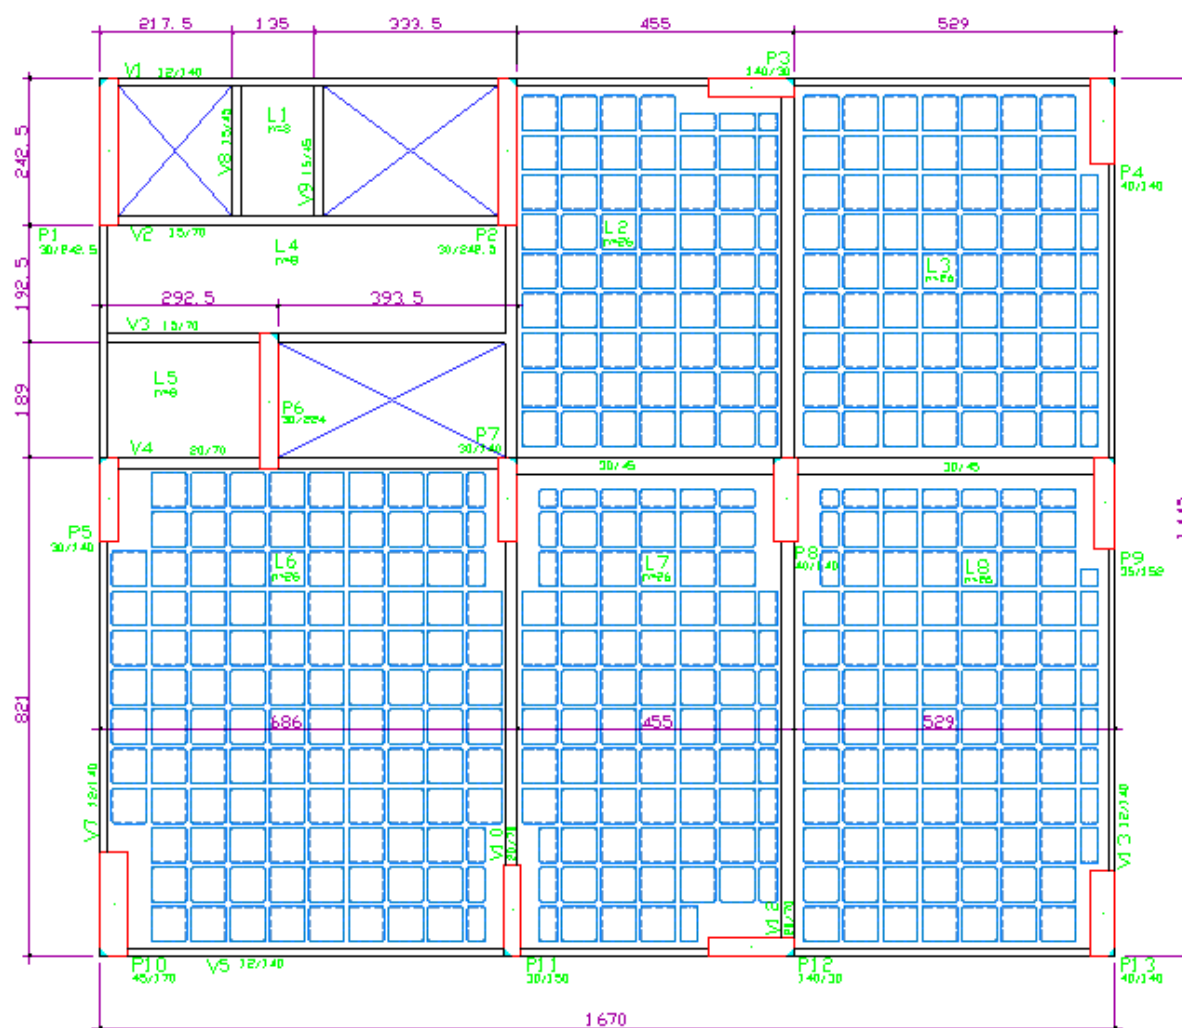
Planta baixa do pavimento tipo do modelo estrutural (Borges, 2009)
